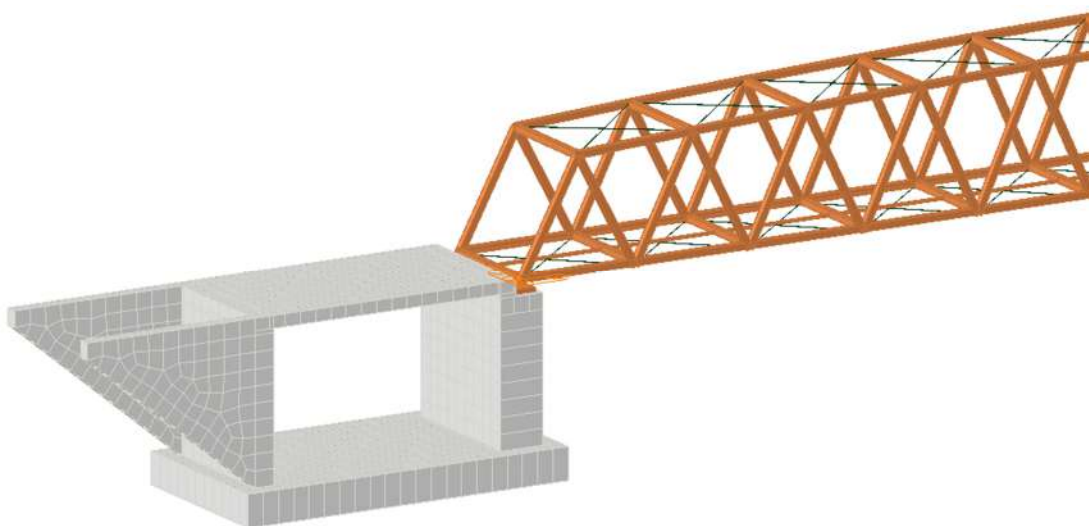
Rendering strutturale – particolare spalla A
